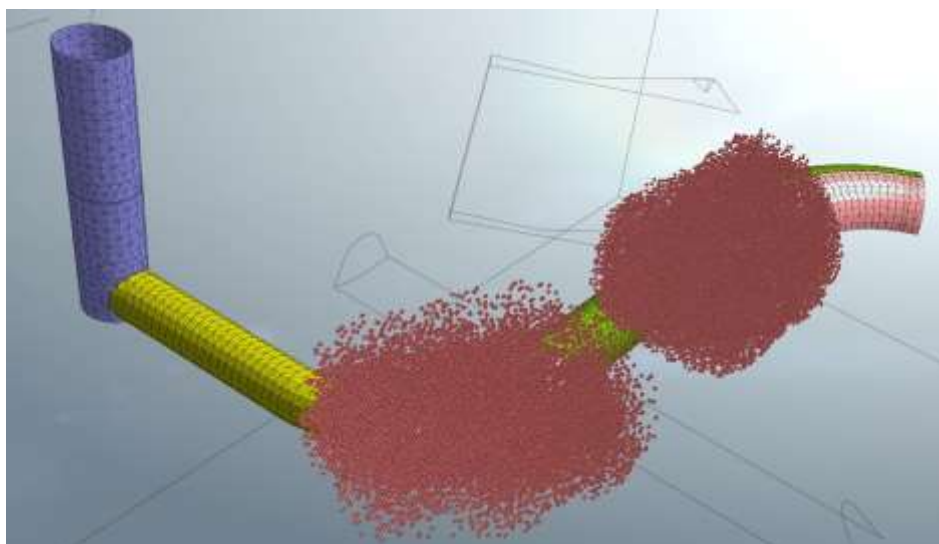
Proinjektovaná oblast – Půdorys 1. části
